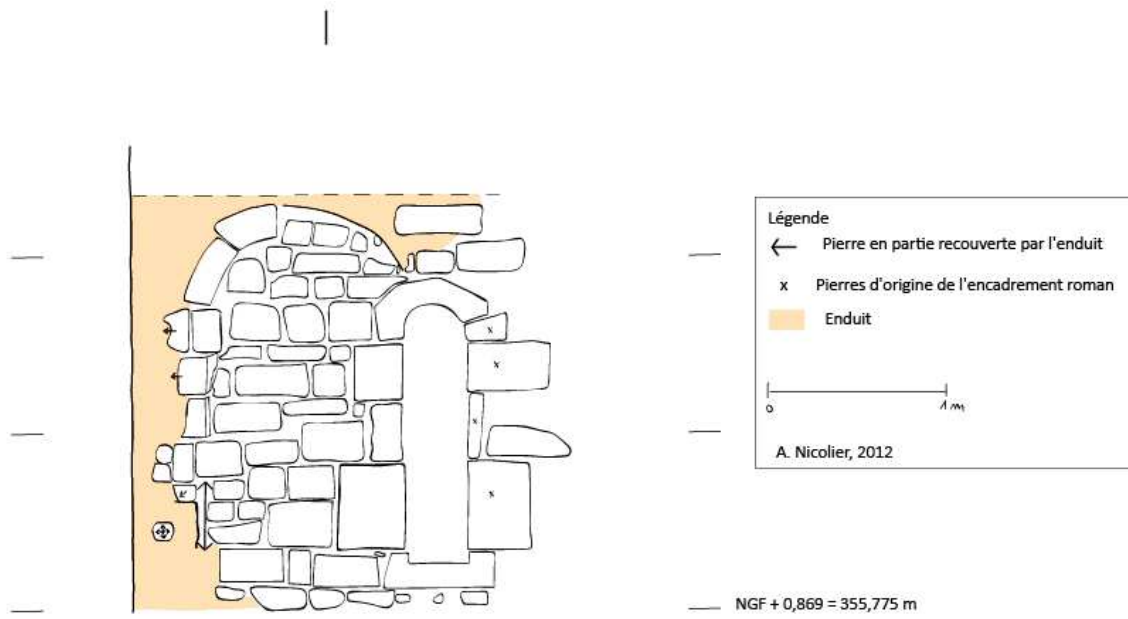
Relevé pierre à pierre de la baie sud de l'abside
